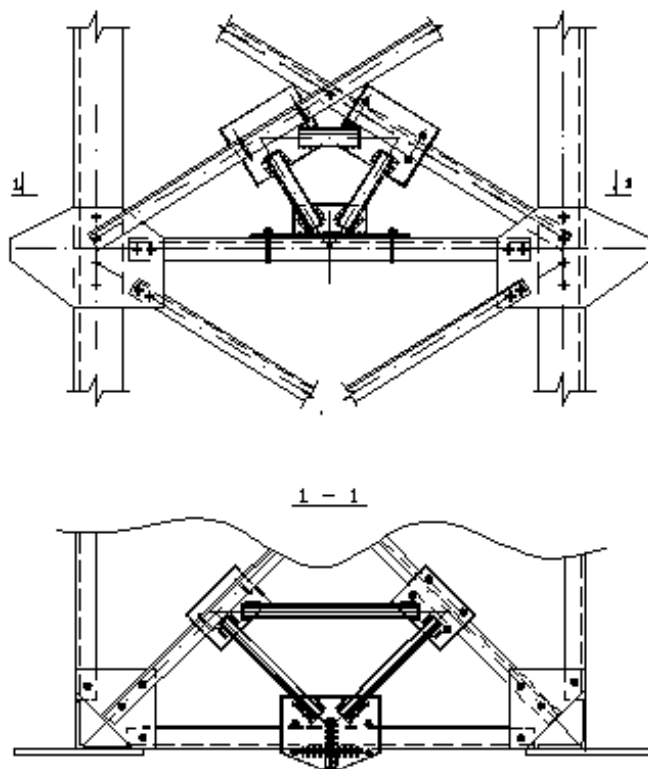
Схема узла для натяжного крепления на решетчатой опоре
